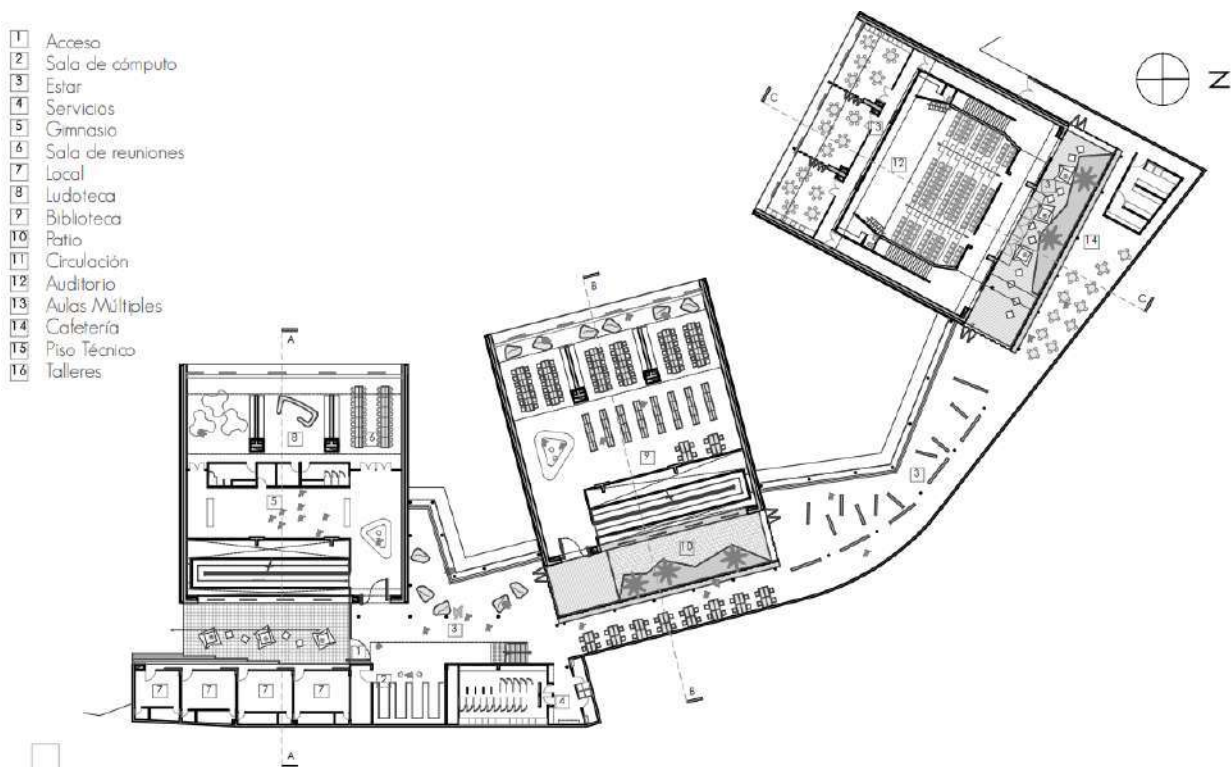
Planta segundo nivel Parque Biblioteca León de Greiff
